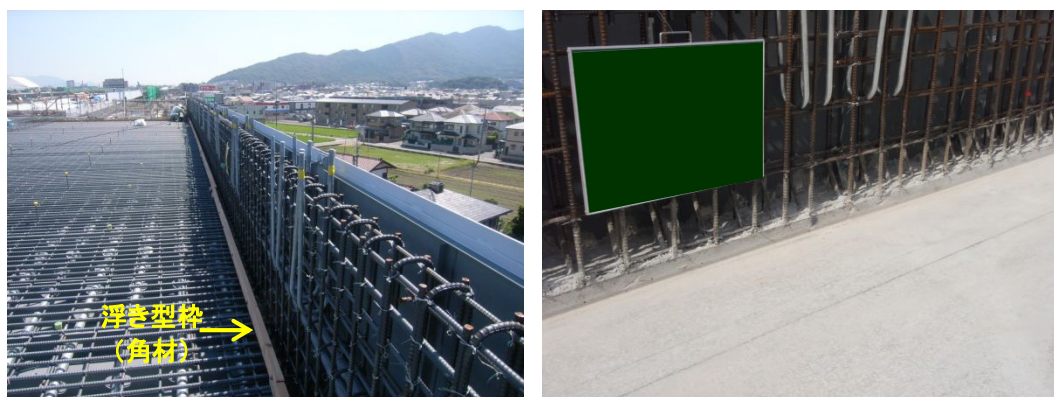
浮き型枠の設置と嵩上げ施工の状況
